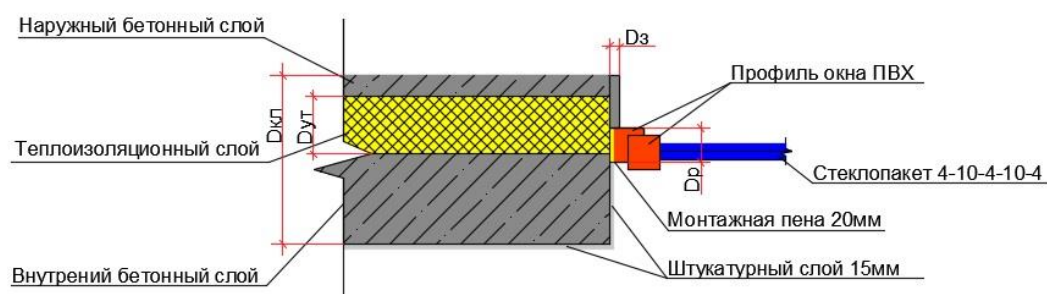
Расчетная схема для ELCUT 6.0 (Крупнопанельная стена)
